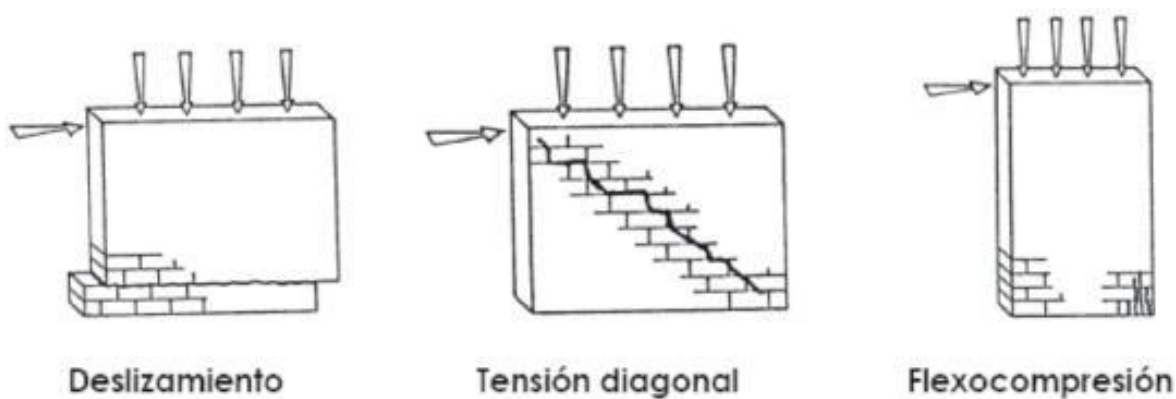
Posibles Modos de Falla en un Muro de Mampostería.
